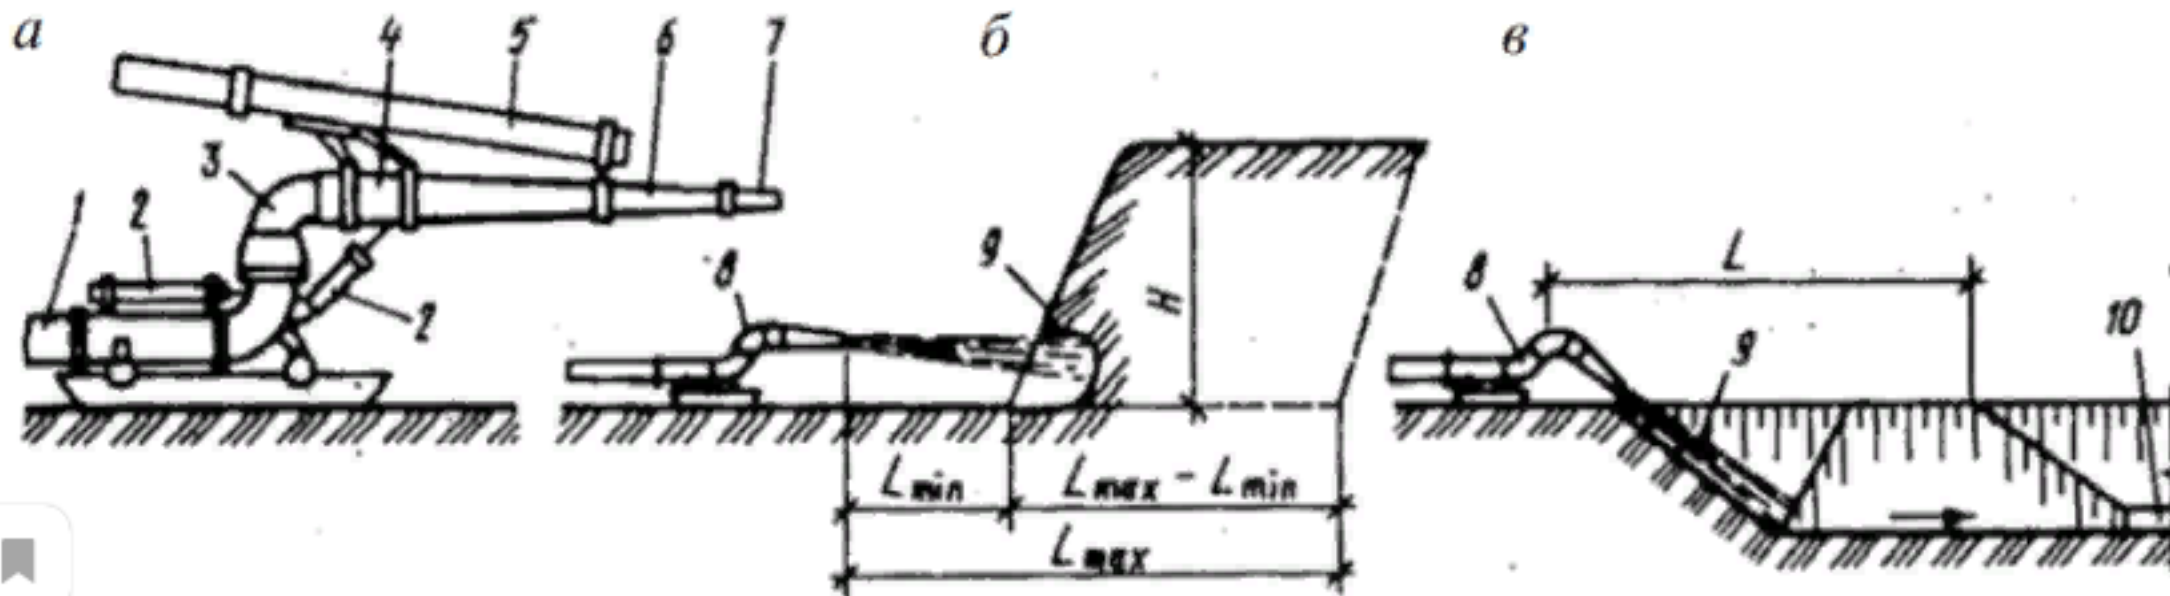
Гидромониторный способ разработки грунта: а – схема гидромонитора; б – встречный забой; в – попутный забой; 1 – водовод; 2 – гидроцилиндры управления; 3, 4 – шарнирное сочленение ствола с водоводом; 5 – рычаг; 6 – ствол; 7 – насадка ствола; 8 – гидромонитор; 9 – фронт забоя; 10 – канава отвода пульпы
